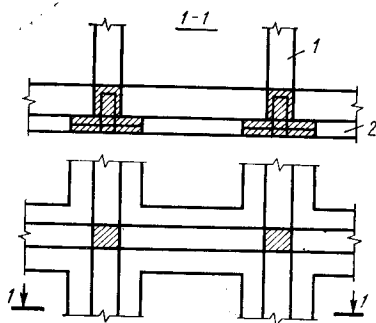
Перекрещивающиеся ленточные фундаменты:
